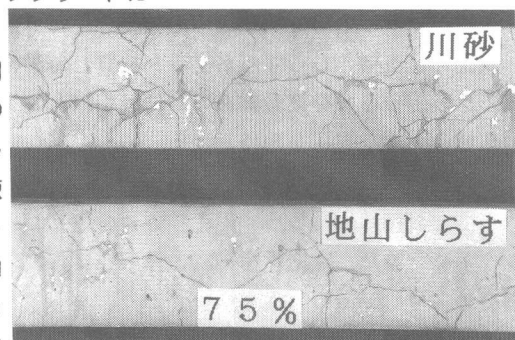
アルカリ骨材反応試験におけるコンクリートのひびわれ状況 (材令: 16週)
